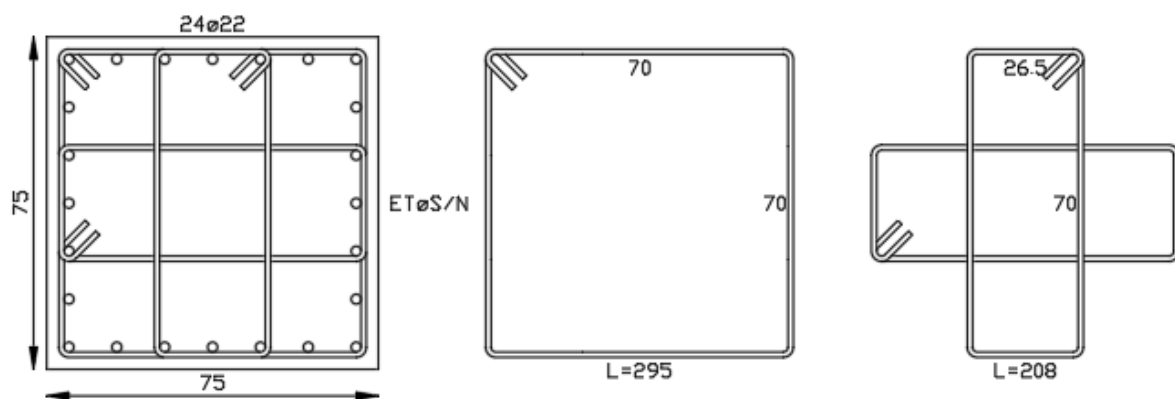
Columnas C01, Edificio 15 pisos.
